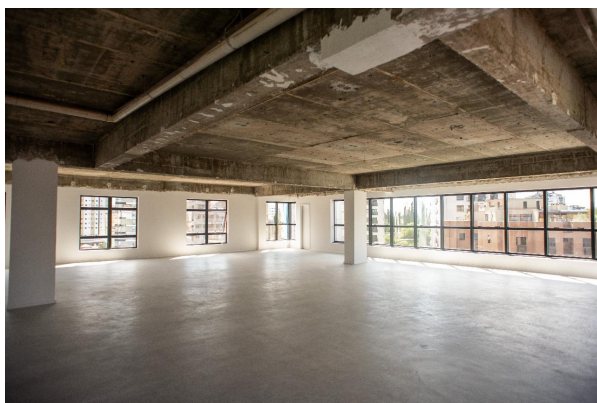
Imagem ilustrativa do 1º ao 6º pavimento.
